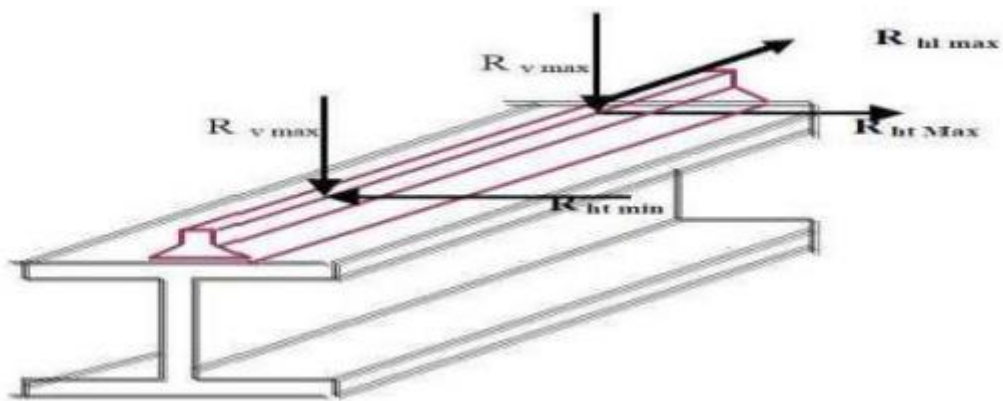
Schéma de la poutre de roulement avec le rail.
